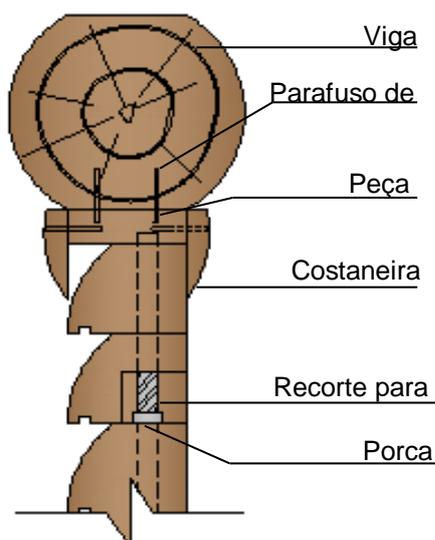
Vista superior do detalhe de ligação entre os módulos de vedação e as peças de acabamento entre vedação e pilar
